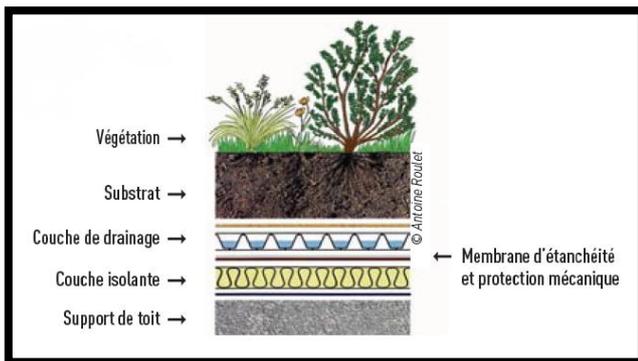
coupe d'un toit source : site web www.caue-martinique.com
